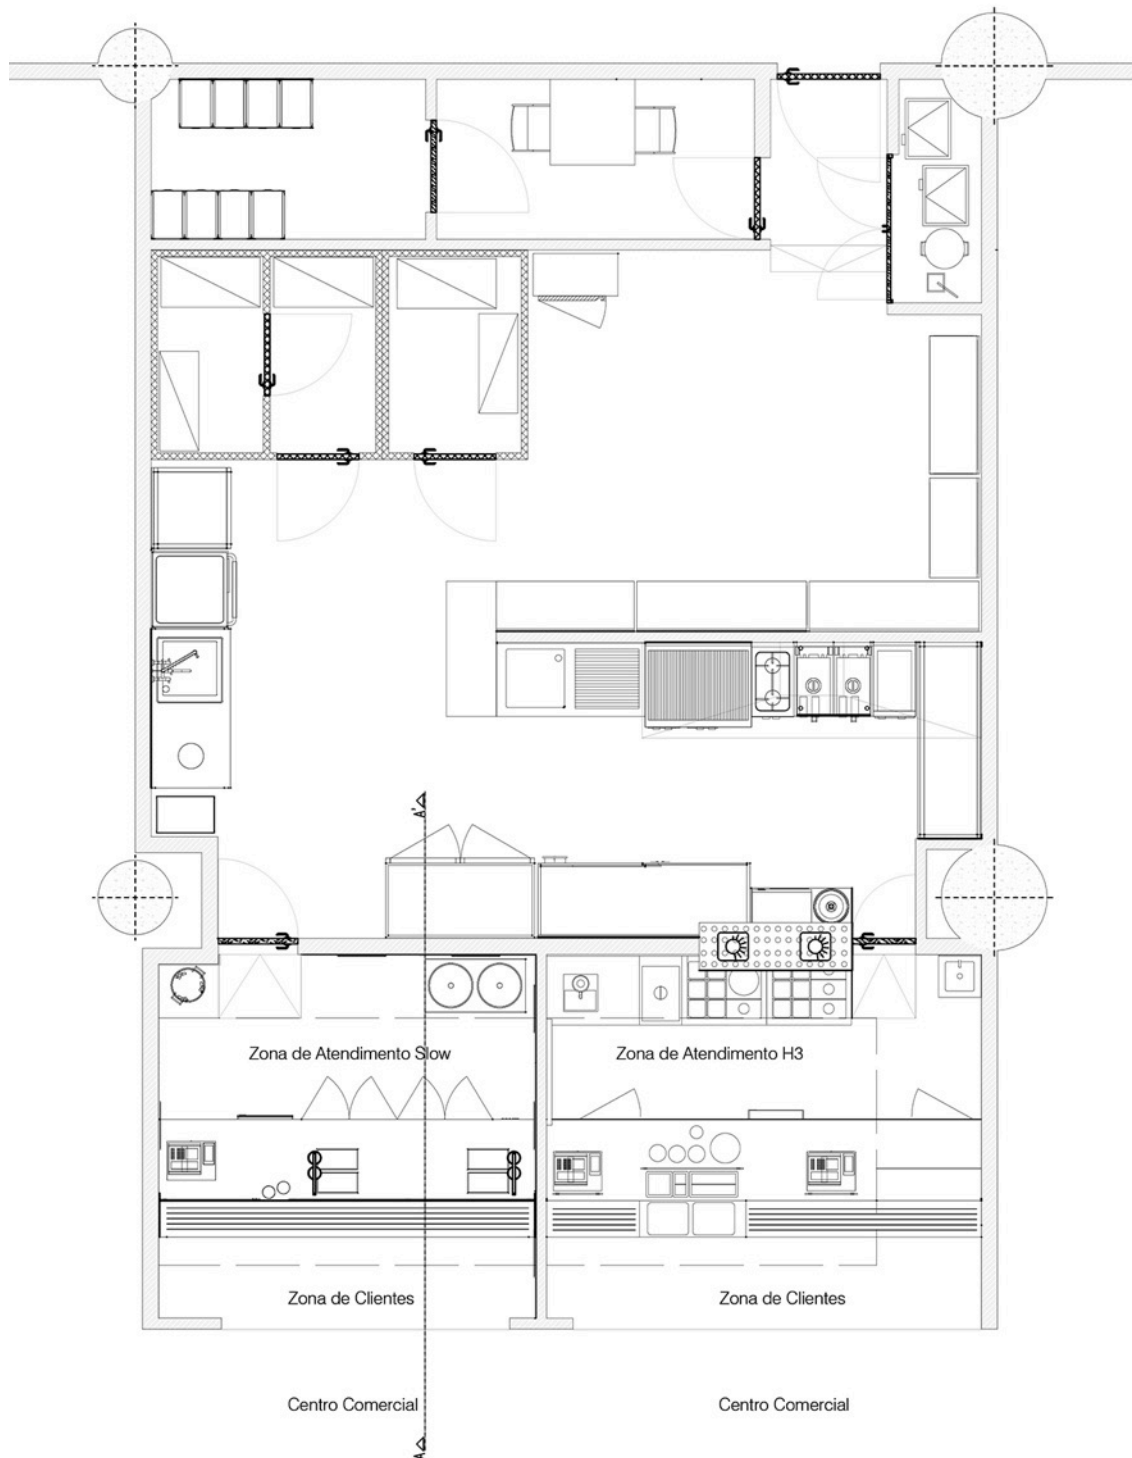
Planta da loja, já com a proposta do novo restaurante Slow, e a compressão do New Hamburgoloy h3
